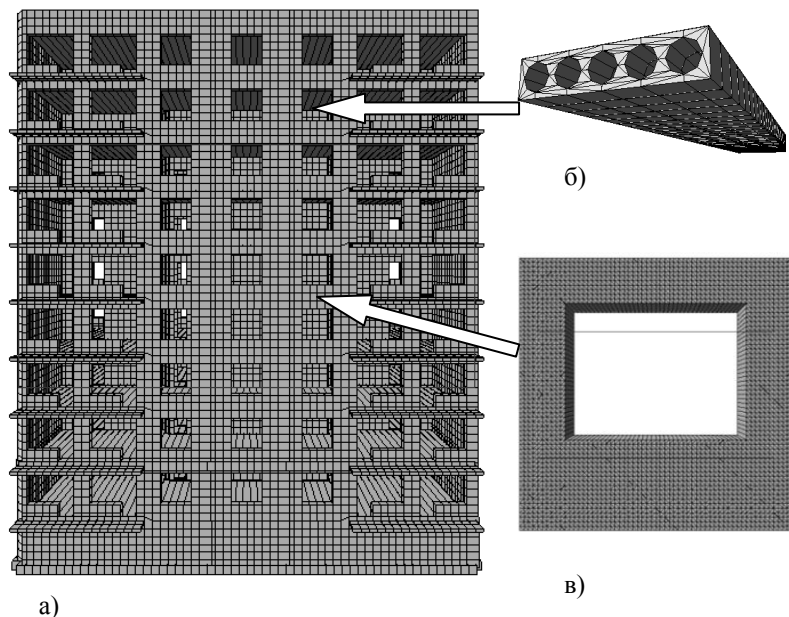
Расчетные модели типовых сборных железобетонных конструкций жилого крупнопанельного здания с предварительными деформациями: а) модель типовой секции; б) модель многопустотной плиты перекрытия; в) модель стеновой панели с проемом
